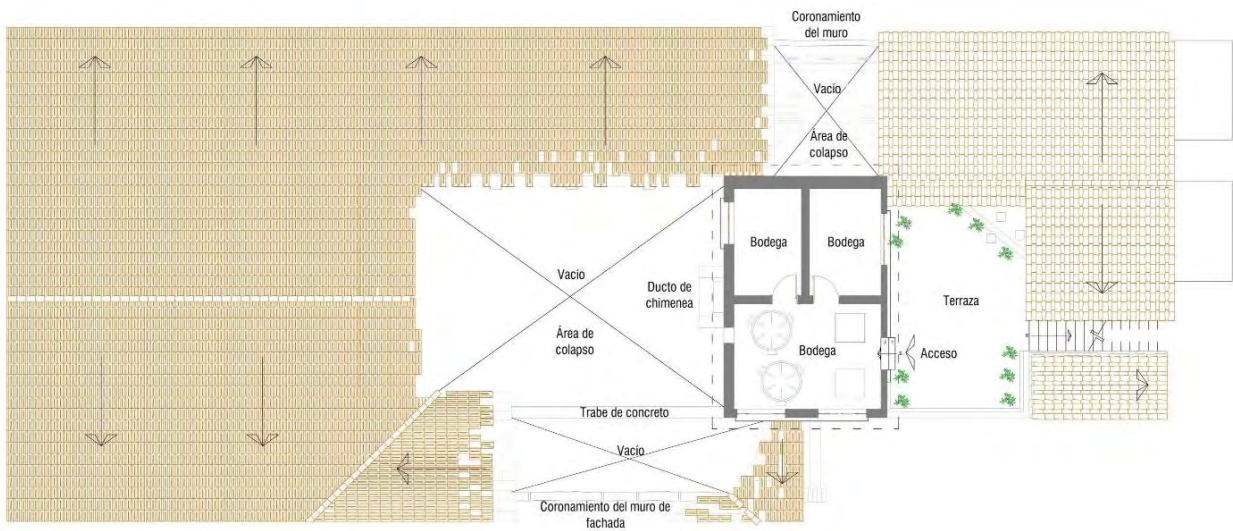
Estado actual de la planta alta. EPG 2014.
